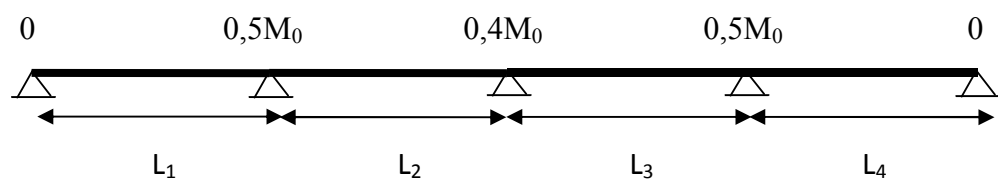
Schéma statique des poutrelles à plus de deux travées.
